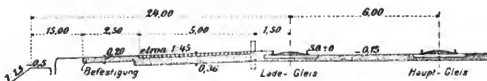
Querschnitt durch die Ladestraße eines Nebenbahnhofes.
